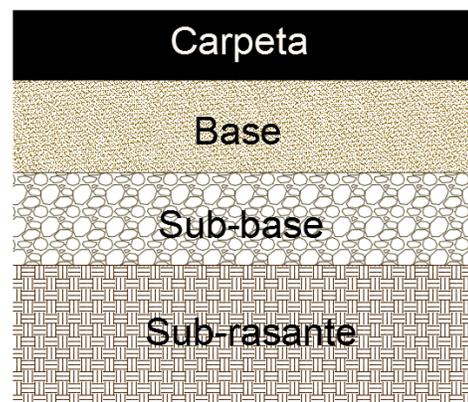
Estructuración de pavimento flexible. Fuente: Elaboración propia (2016) AutoCAD.
